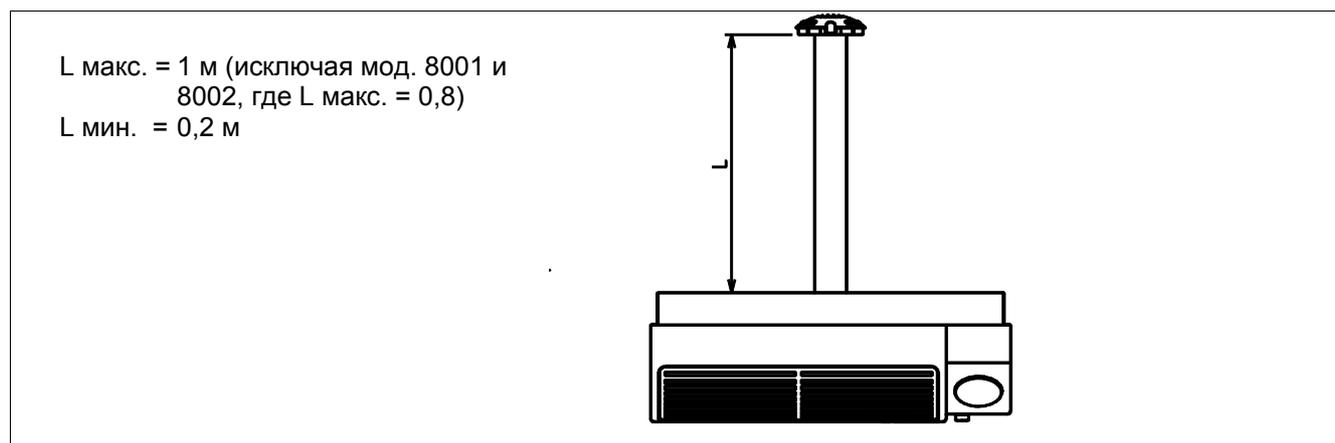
УСТАНОВКА С СООСНЫМИ ТРУБАМИ
